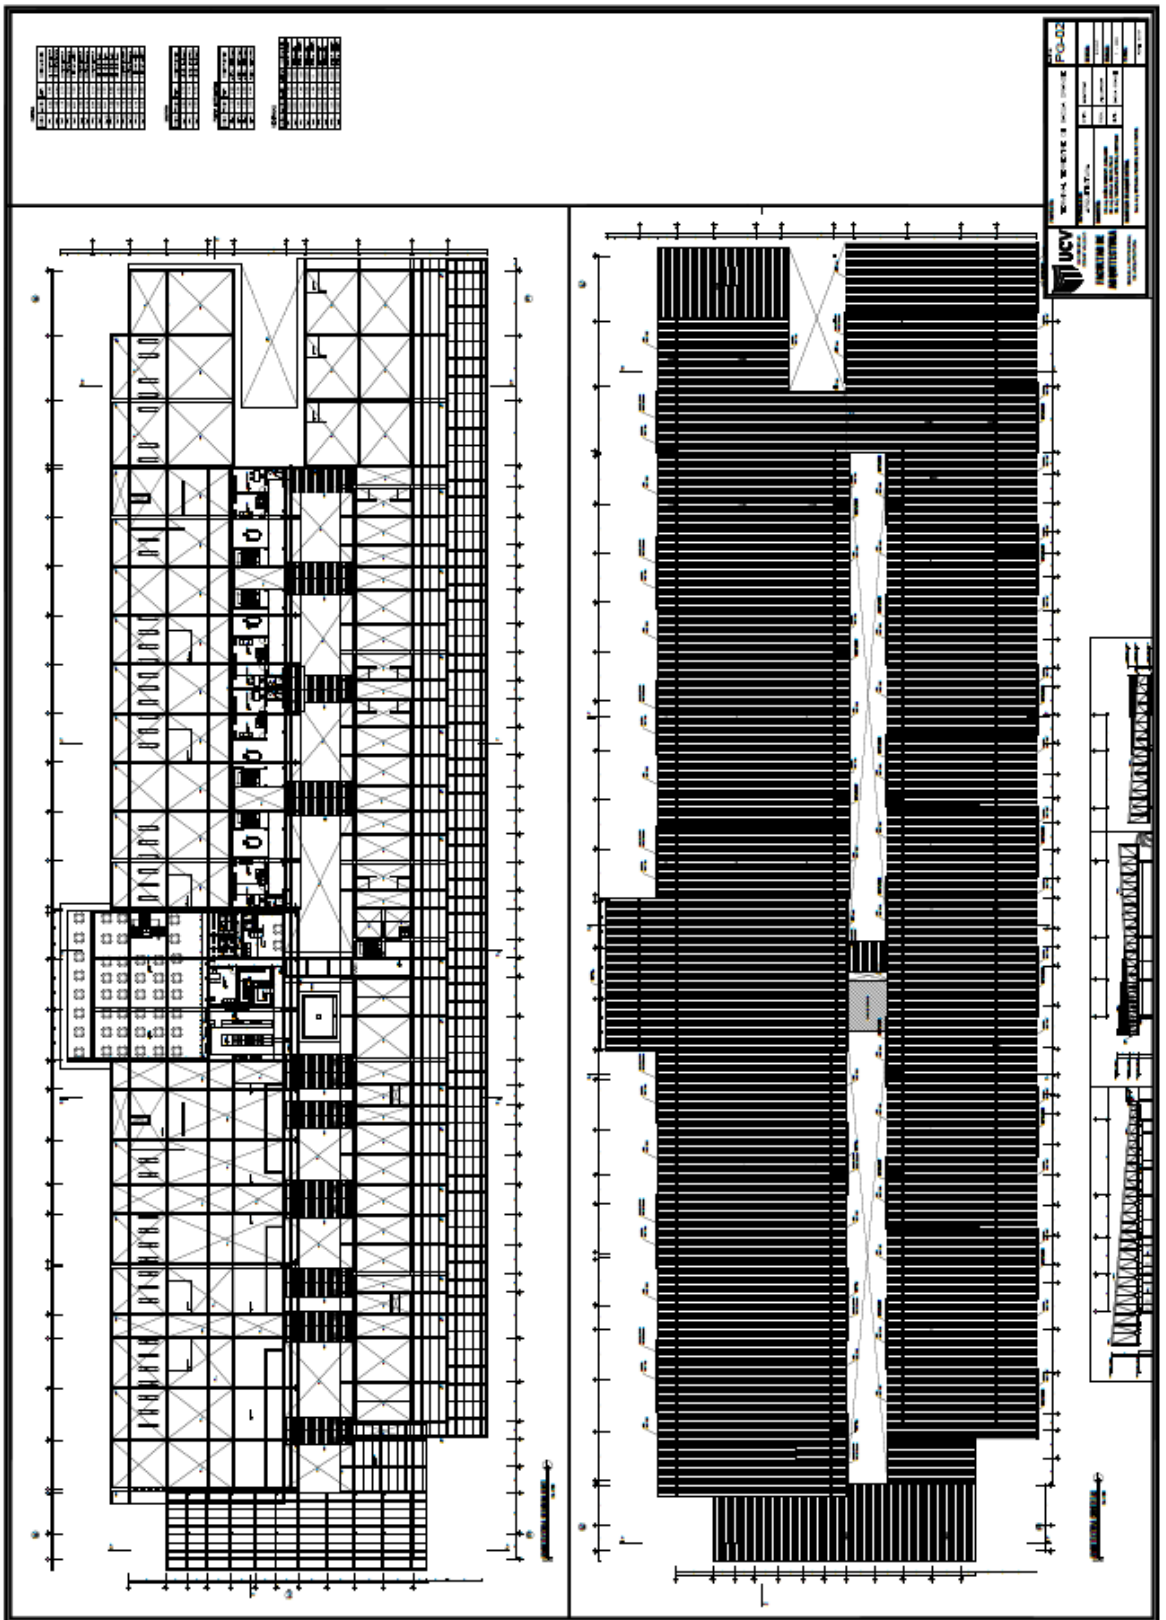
PLANO GENERAL SEGUNDO PISO Y CUBIERTAS
